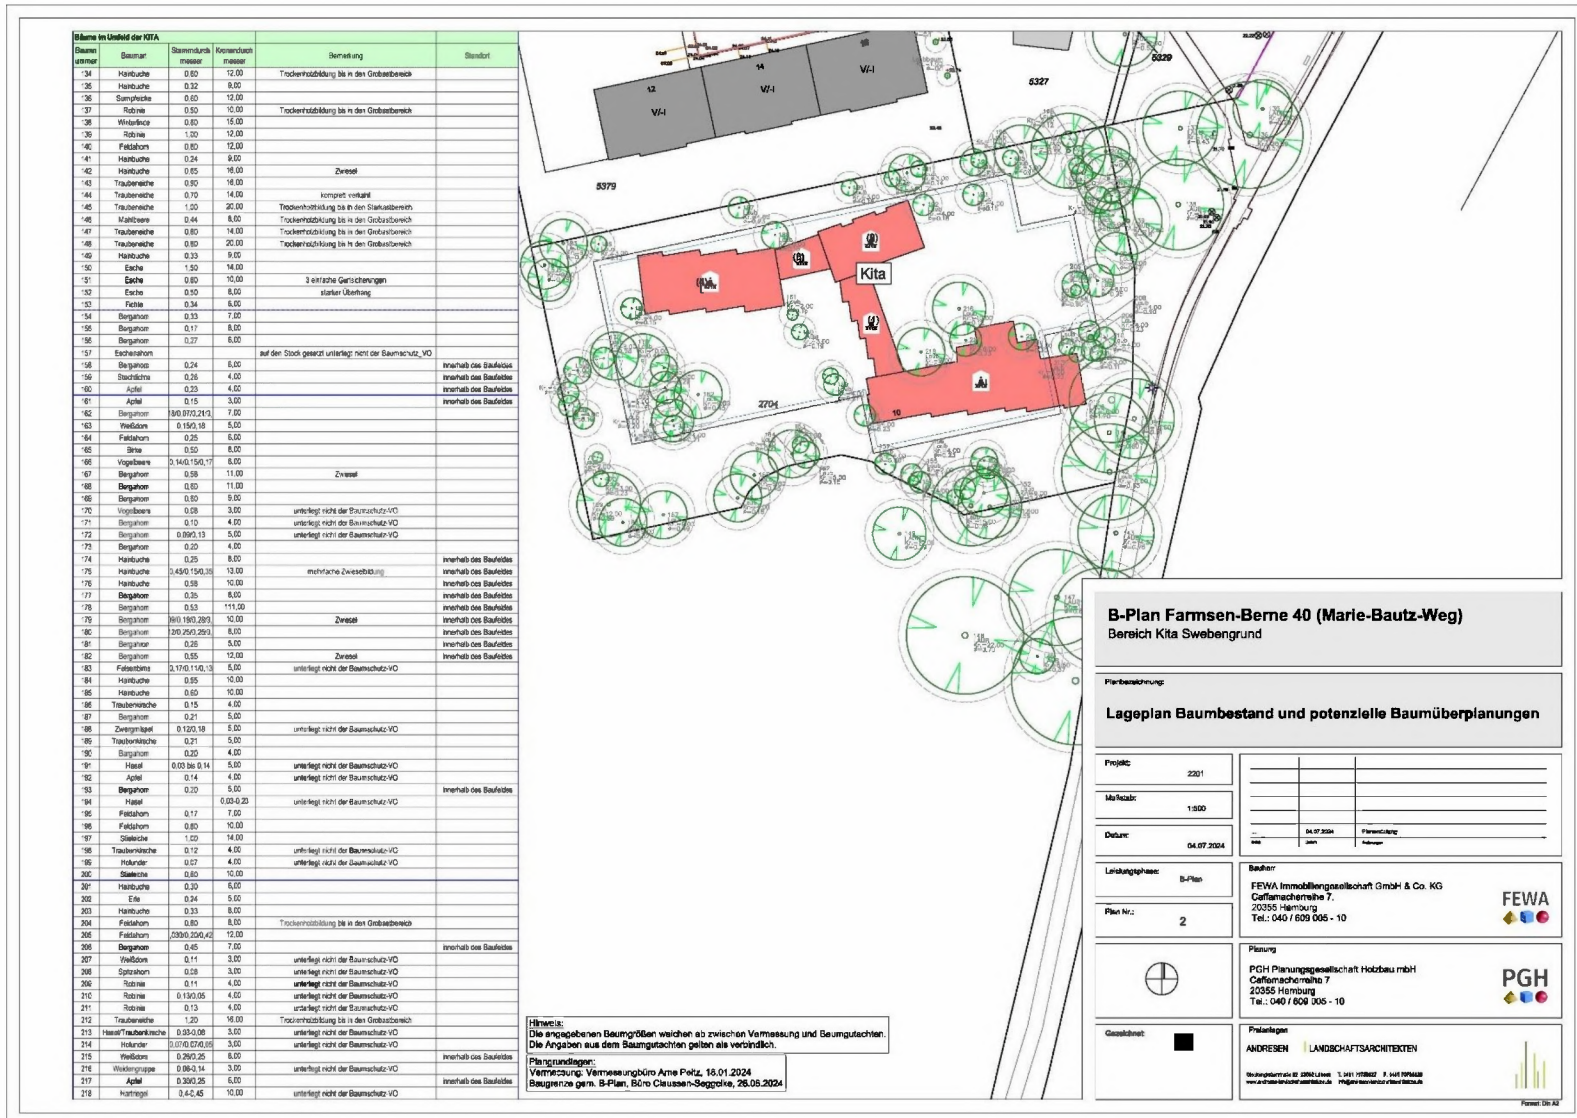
Lageplan zum Baumgutachten, Teilbereich Kita (Verkleinerung)
